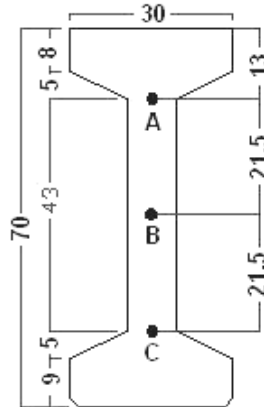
Dimensões da seção transversal da viga I 70 (em cm)
